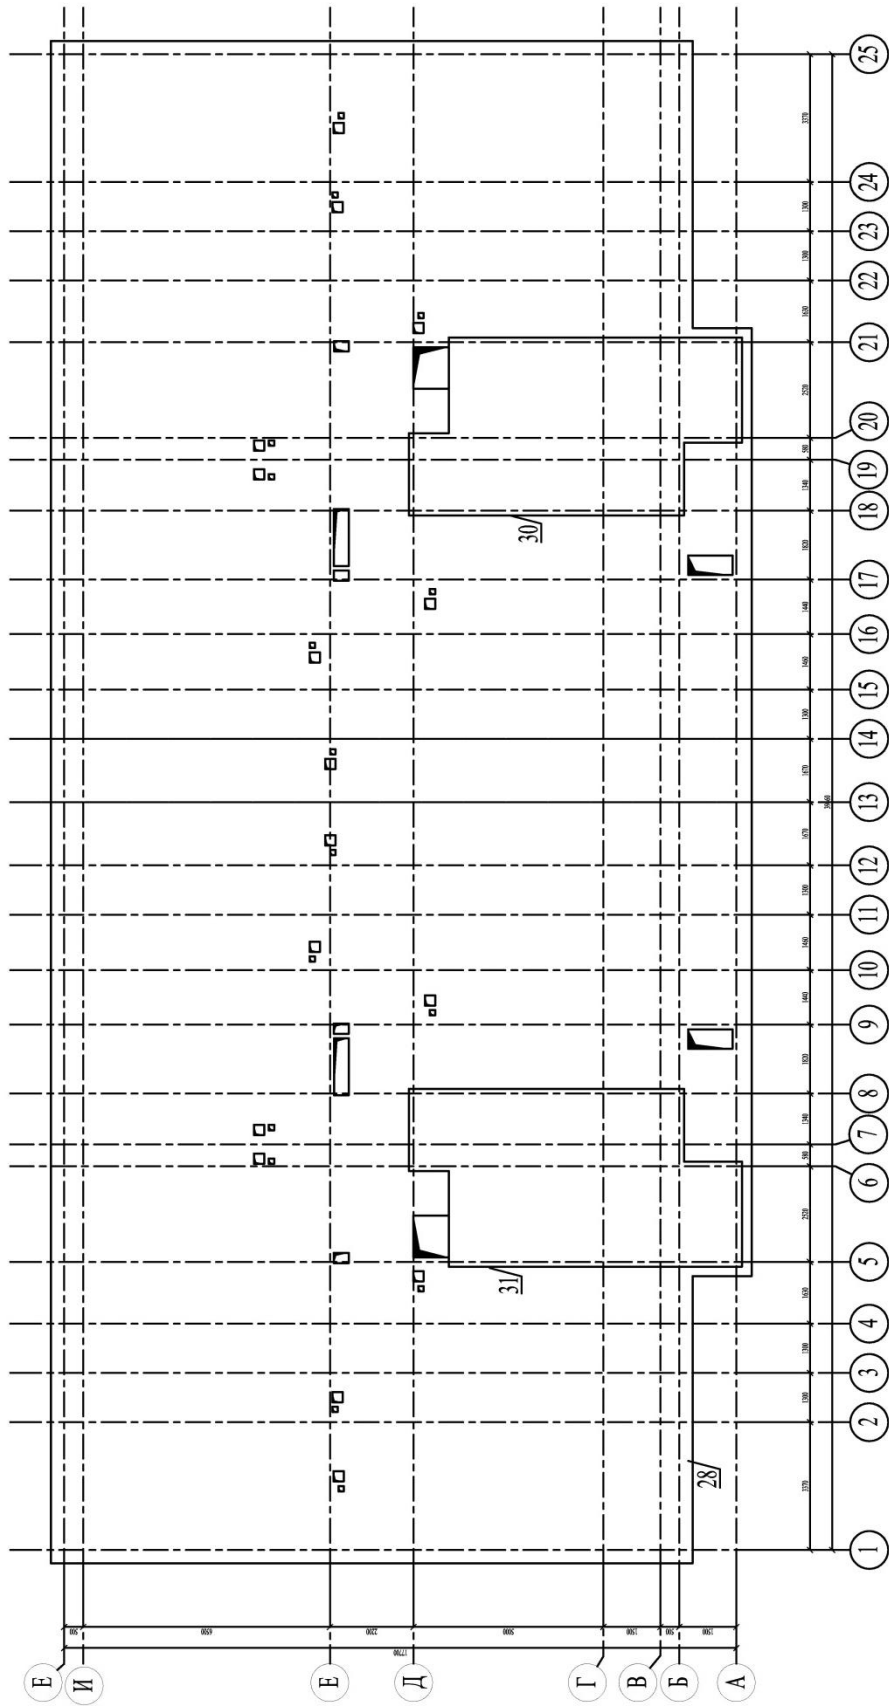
Несущие конструкции покрытия кровли
